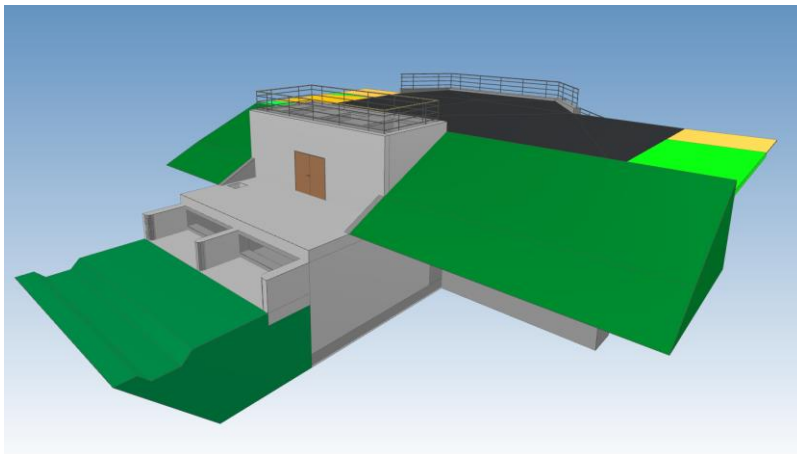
3D-Modell, in Damm integriertes Schöpfwerk, Dammböschung und Kranstellfläche
